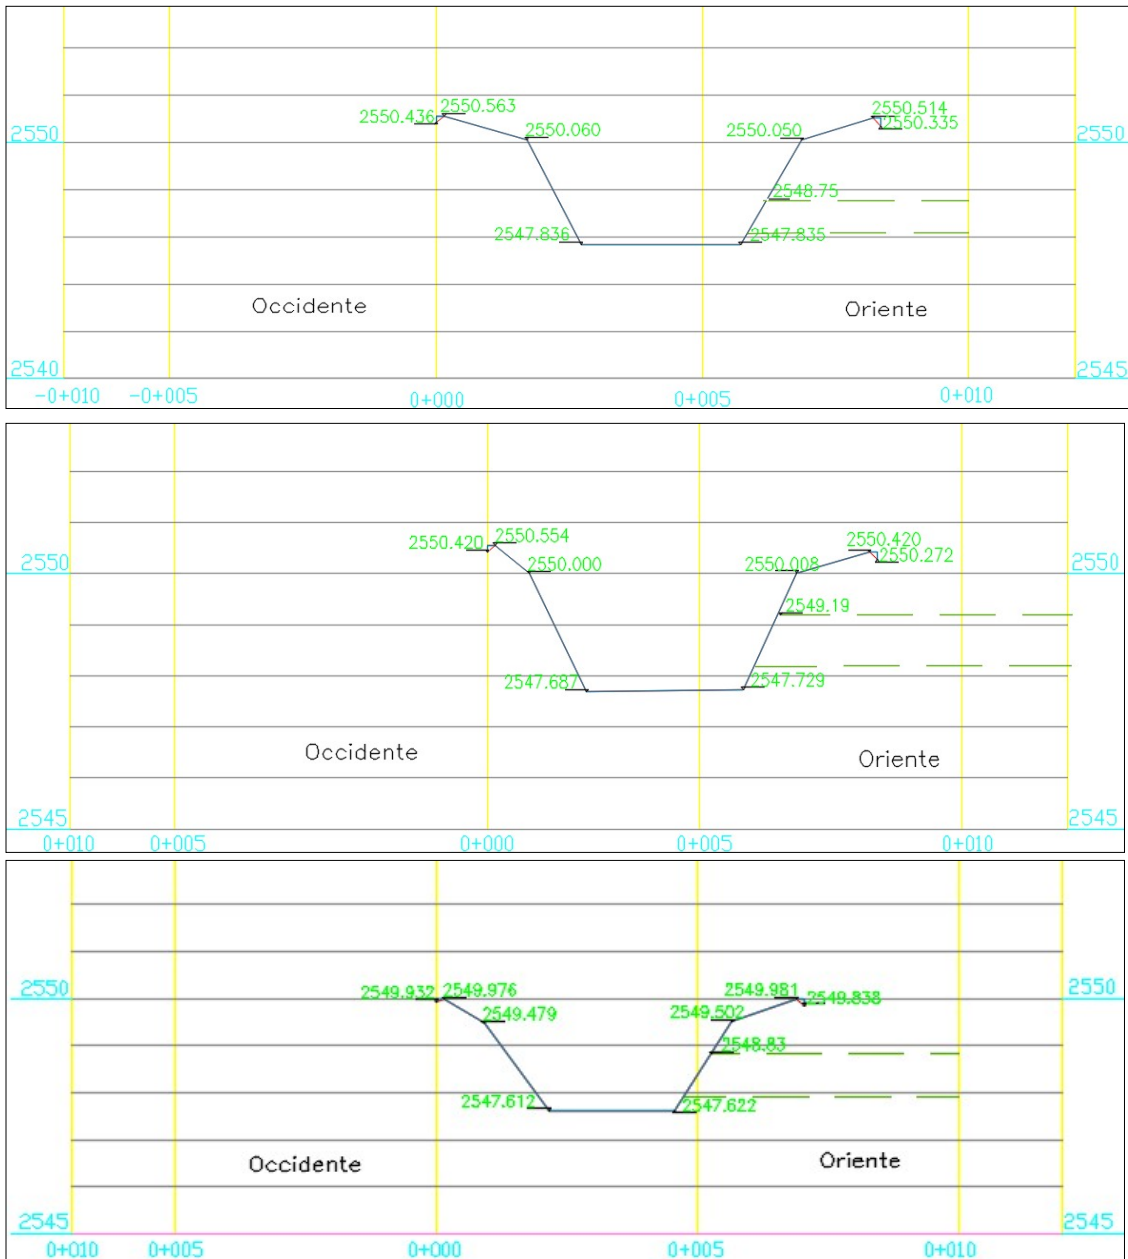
Resumen-Proyectado alcantarillado pluvial entregas sobre canal Boyacá
